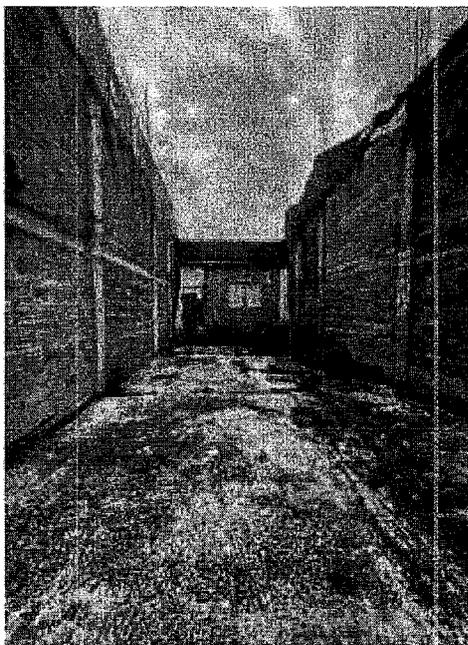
VISTA DESDE EL INTERIOR DEL LOTE, en esta zona se observan columnas y vigas confinadas, para muros de cerramiento
